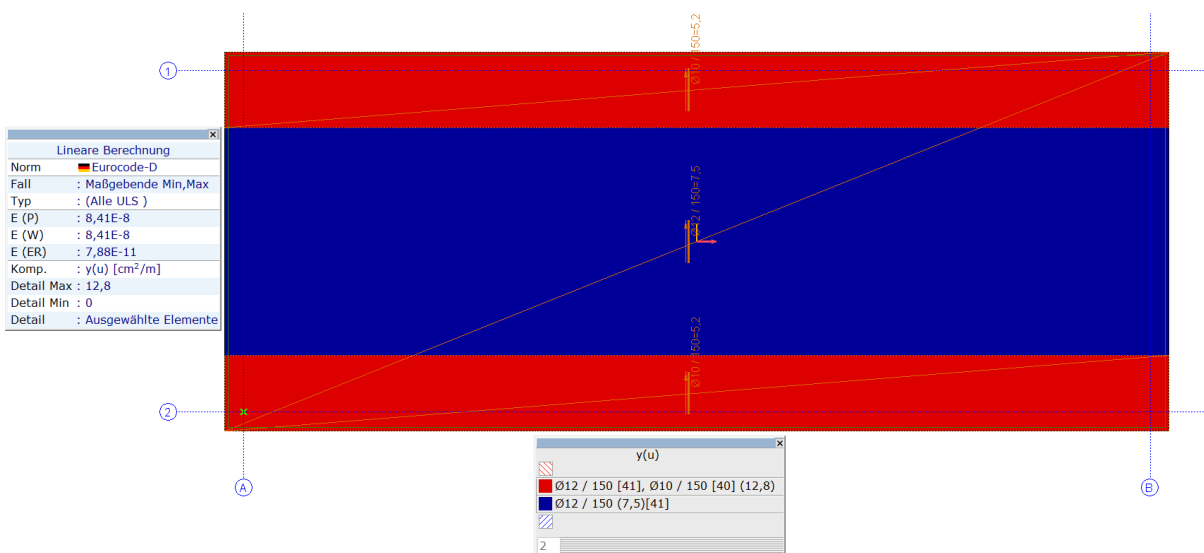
Entworfenere untere Bewehrung in lokaler y-Richtung
